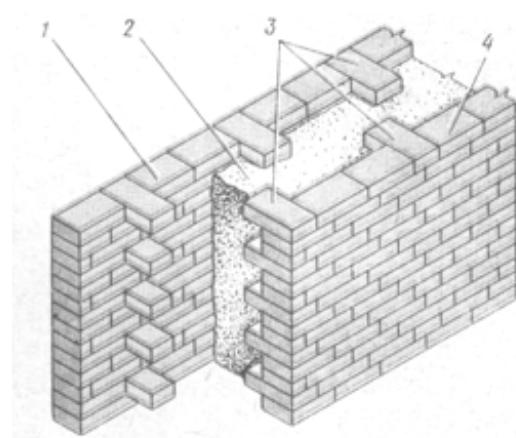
Кирпично-бетонная анкерная кладка: 1 – наружная верста; 2 – лёгкий бетон; 3 – анкеры из тычков кирпича; 4 – внутренняя верста
